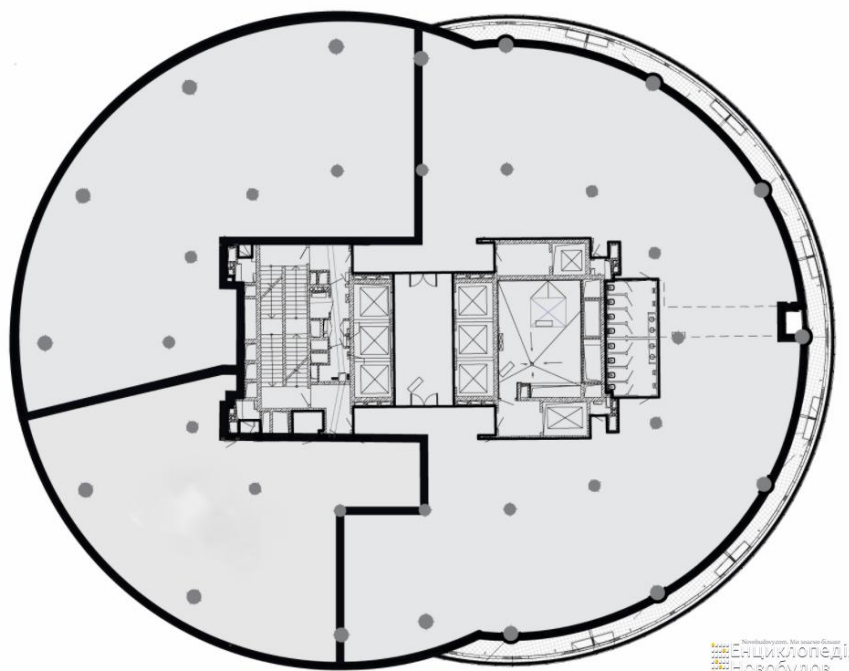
План типового поверху Coworking Space: Regus – Kiev[1]
